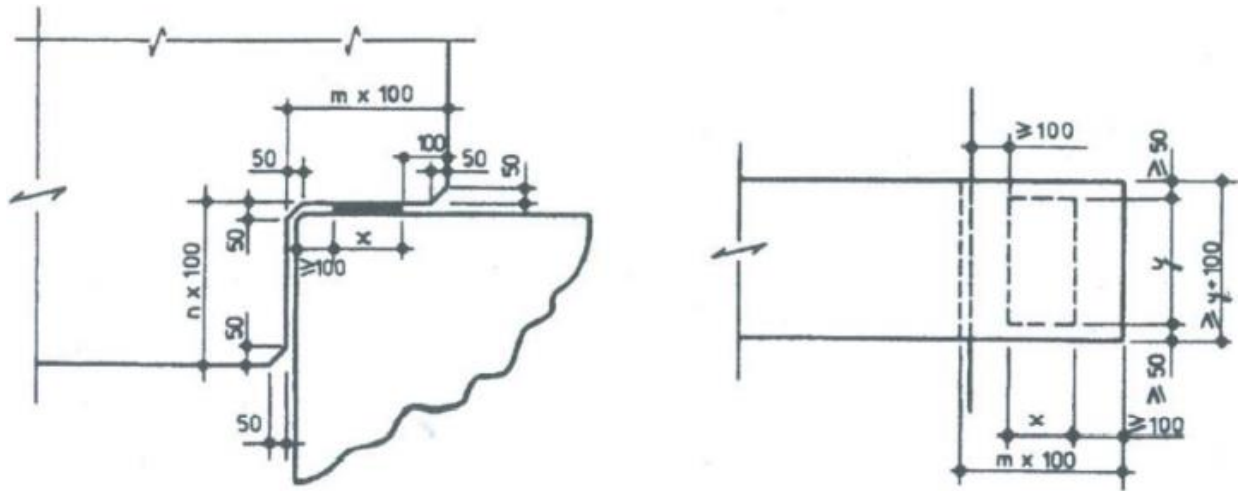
Disposições construtivas da viga e do aparelho de apoio na região do apoio para vigas com consola na extremidade. Fonte: FIB 2004.
